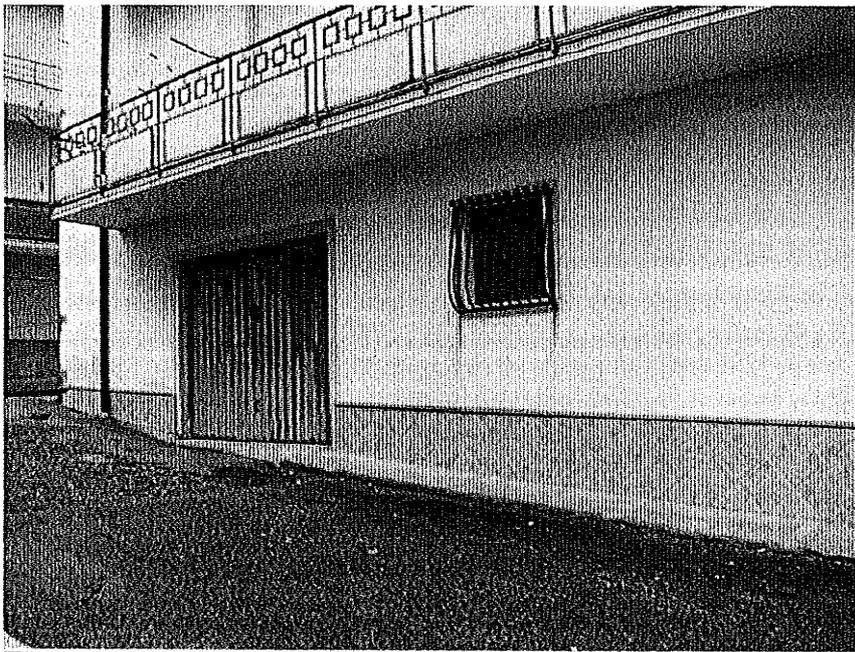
Particolare Prospetto su traversa di via C. Colombo
